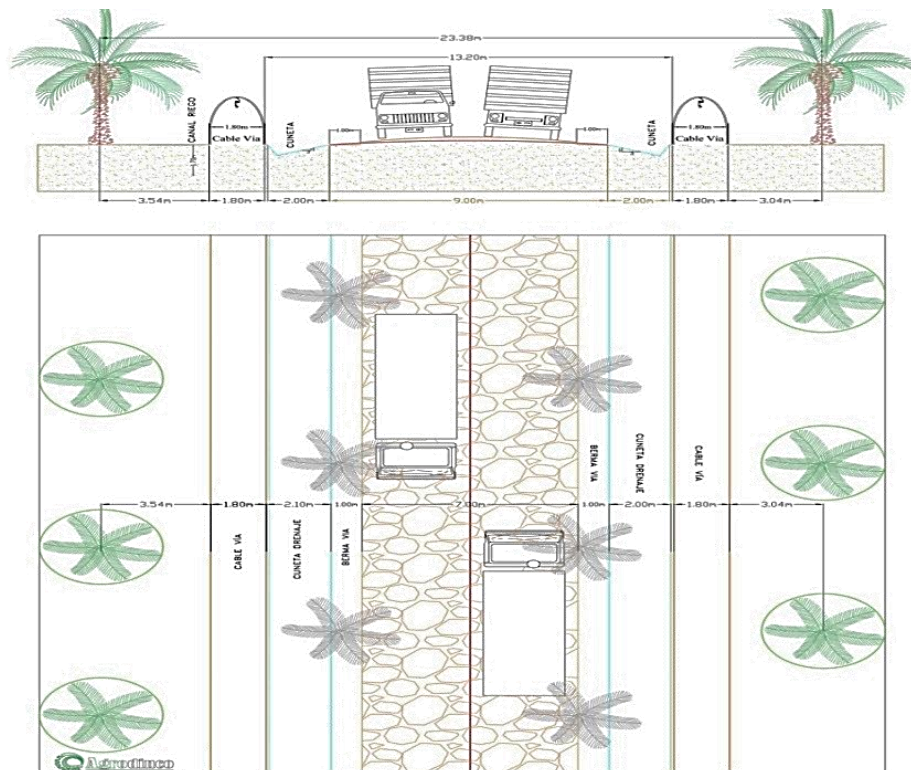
Diseño de construcción de vía en una plantación de palma africana.
